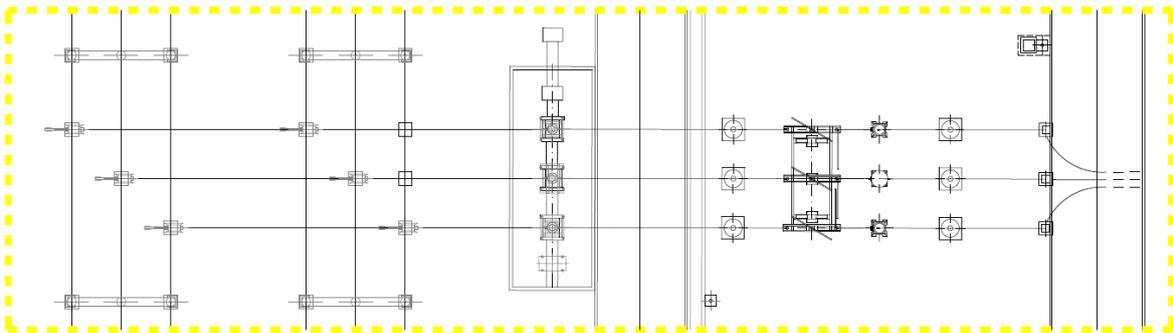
Pianta stallo AT in Stazione Elettrica RTN "Brindisi Sud"
